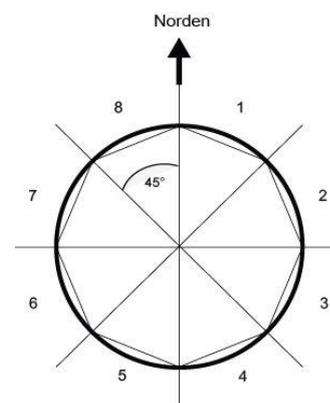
Aufteilung einer Rundfassade in 8 Fassaden
